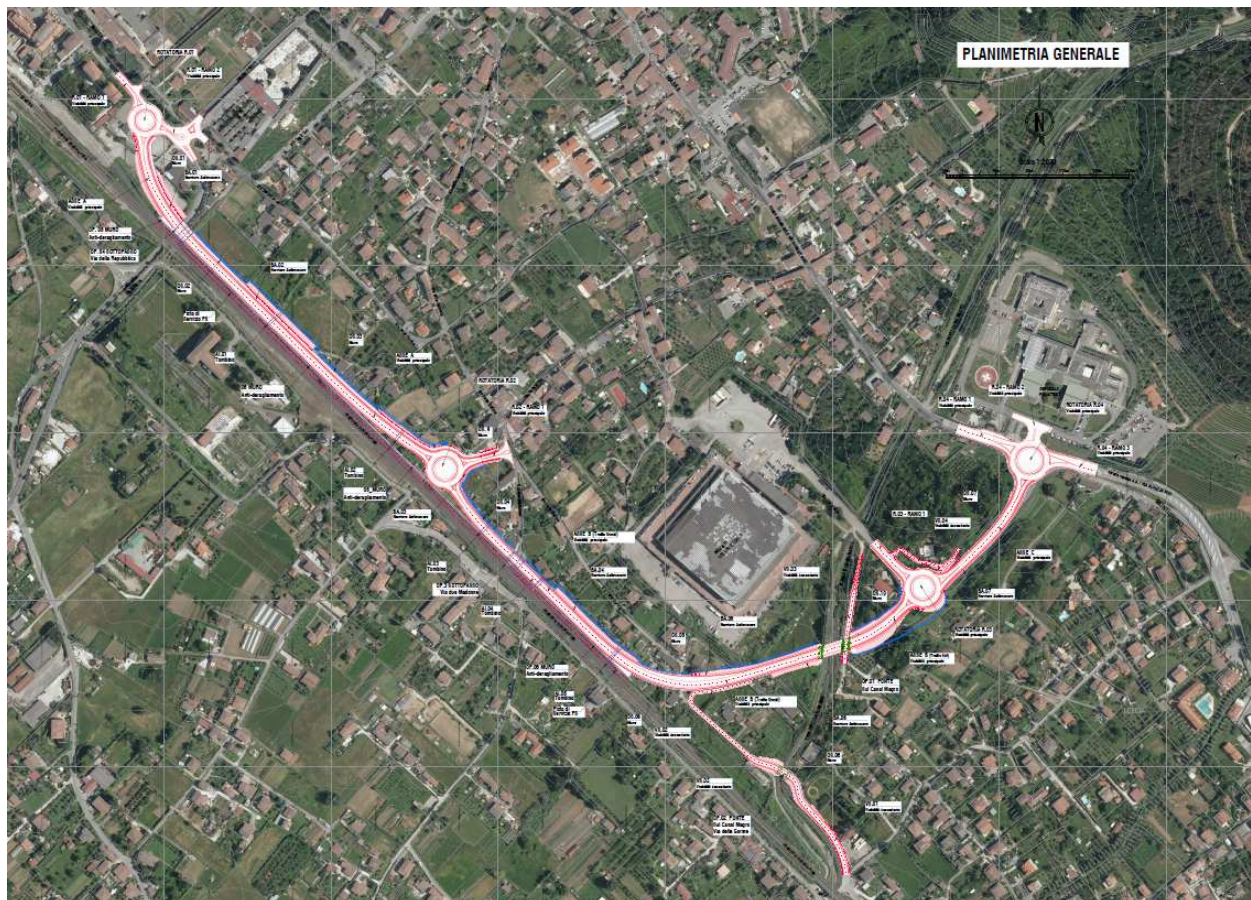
Planimetria di Progetto Definitivo su orto foto
